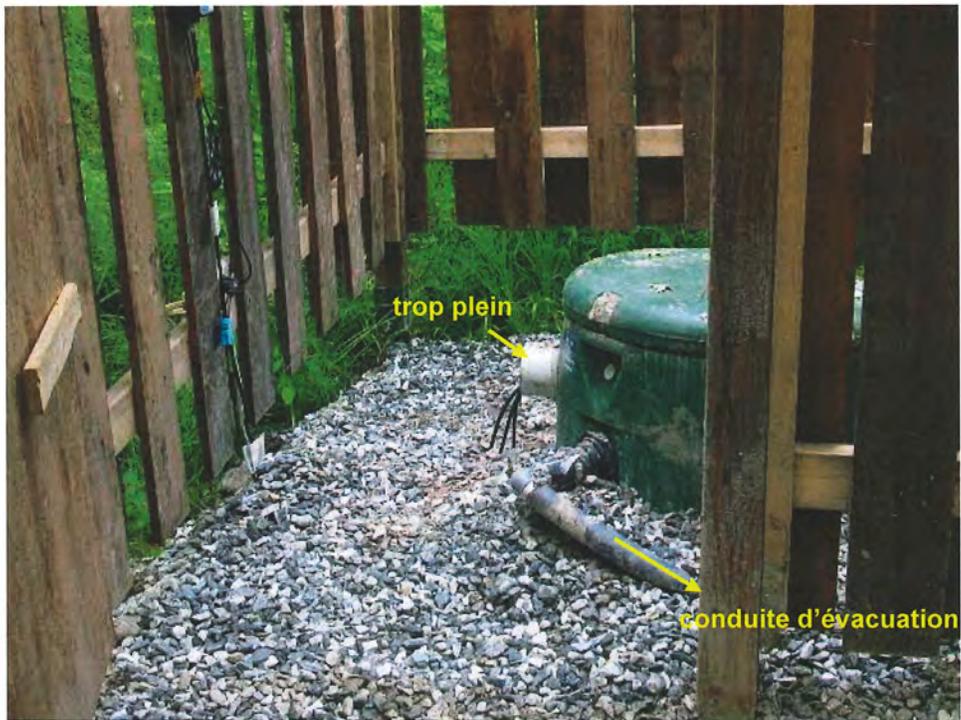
Nouvelle station de pompage 1A située au sud du site 517
